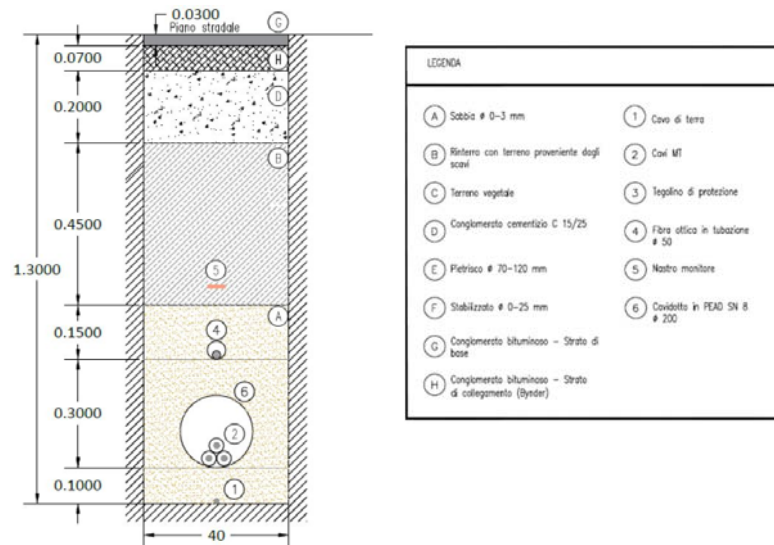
Sezione tipo del cavidotto su viabilità di progetto
